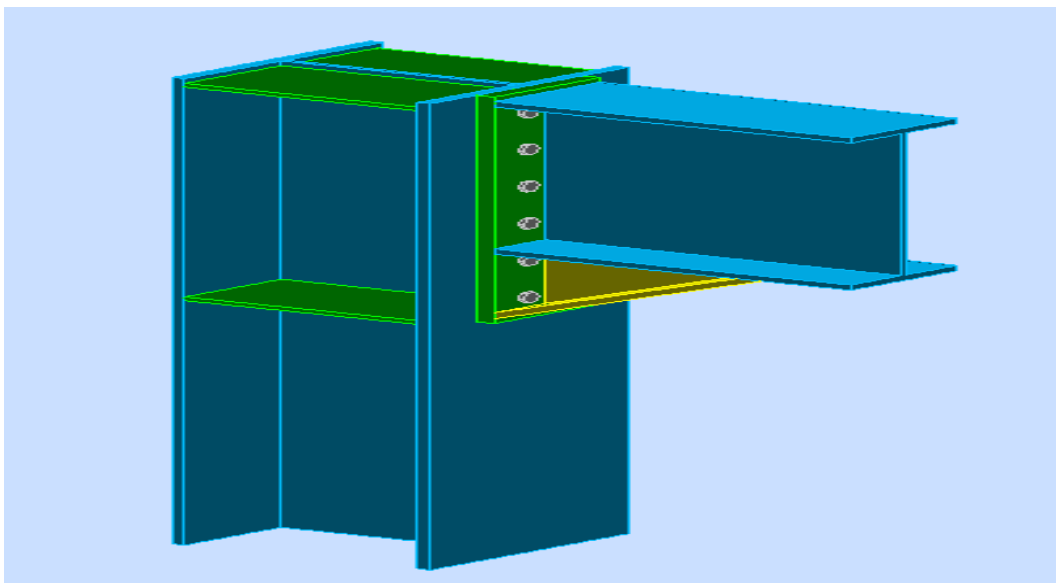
2: Vue de l'assemblage poteau - poutre maitresse.
